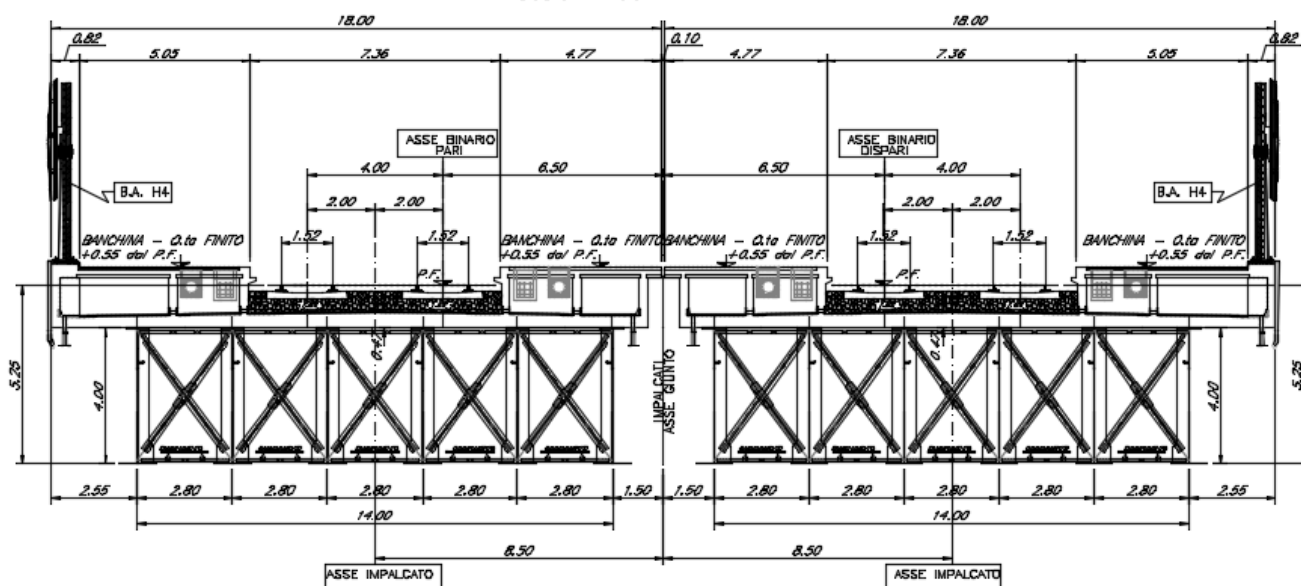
Viadotto fiumara d'Agrò: sezione trasversale e prospetto binario pari
